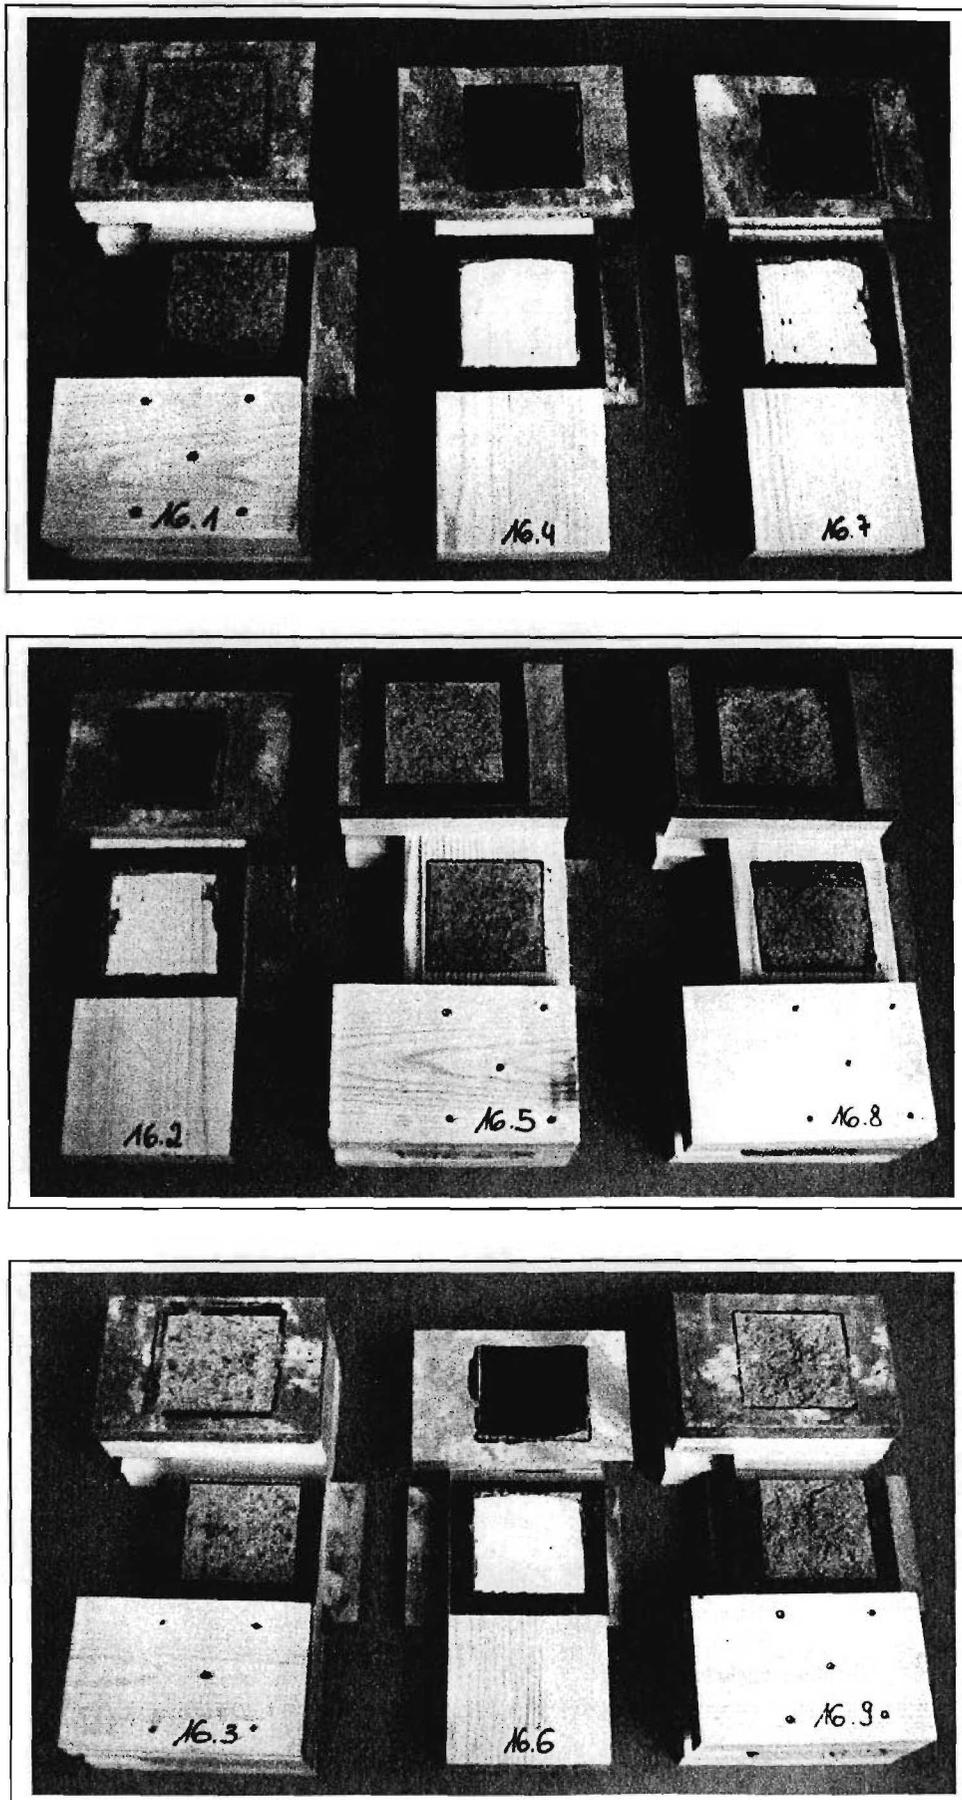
Bruchbilder von Klebverbindungen "Klebstoff K4 - Plattentyp B1 - Fichtenholz"
